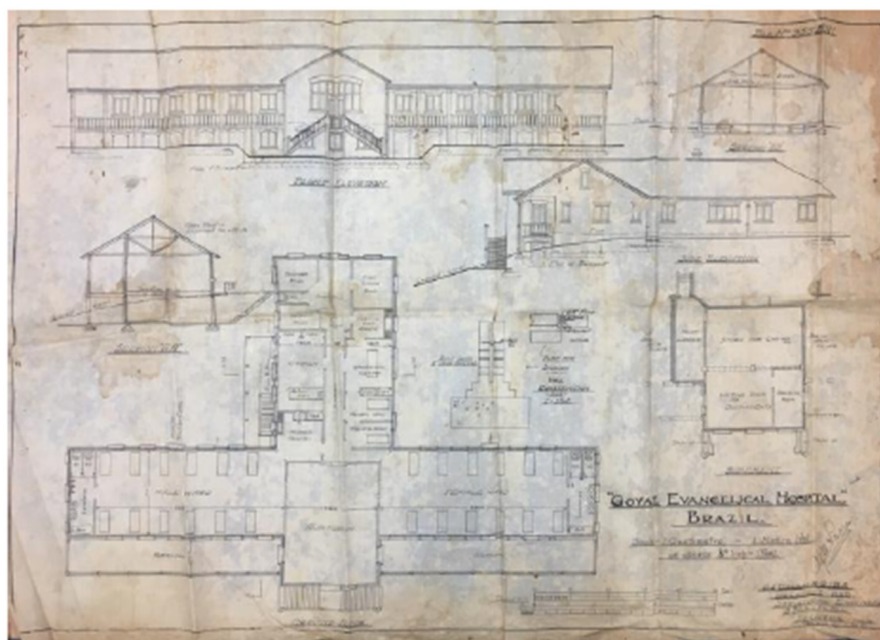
Planta original do *Goyas Evangelical Hospital*.
